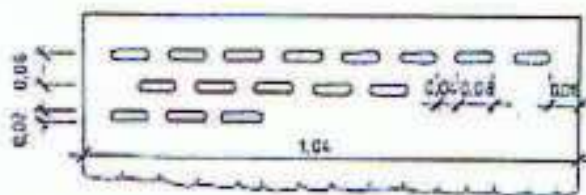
DETAIL PŘÍČNÉHO SPOJENÍ ZATRAVŇOVACÍCH ROHOŽÍ
